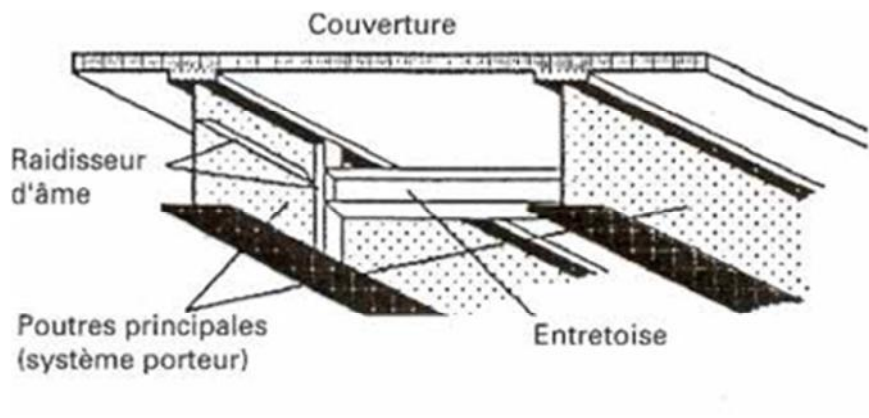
Schéma d'une coupe transversale d'un pont mixte
